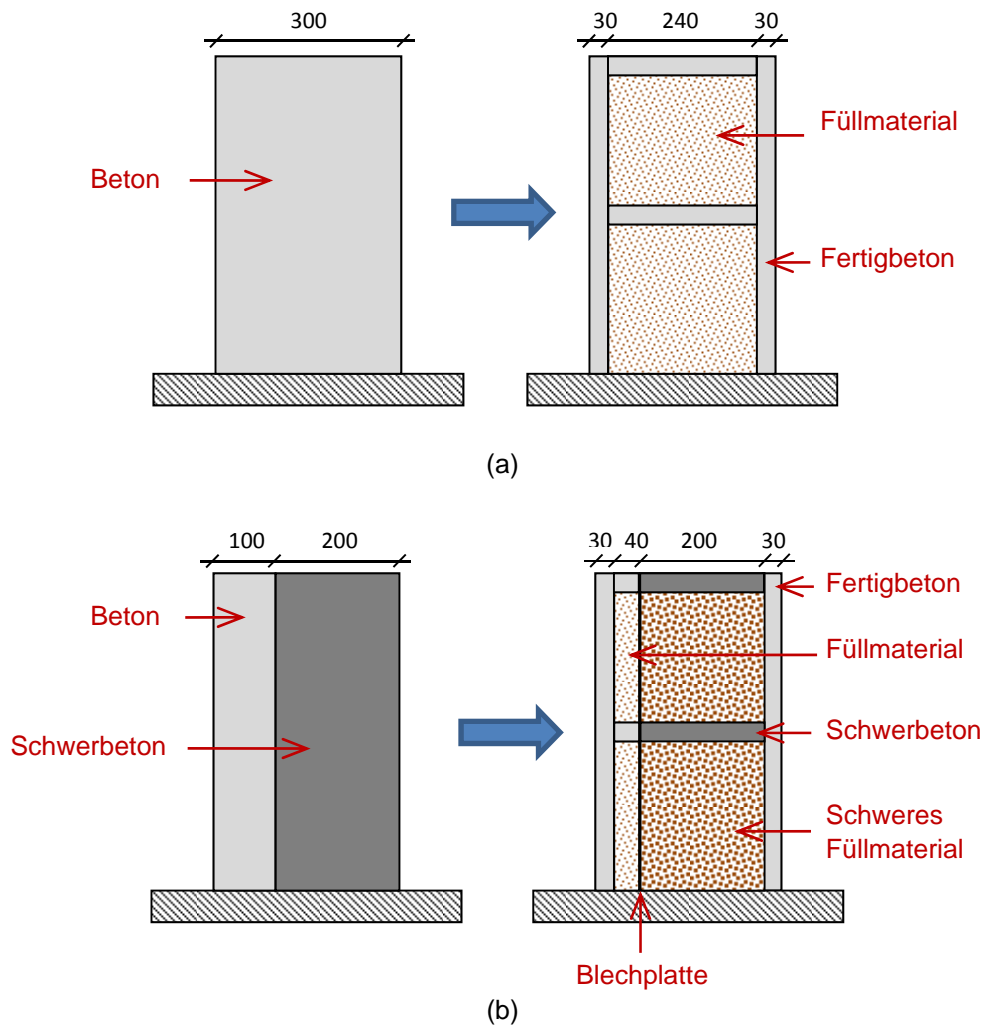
Schematische Darstellung der Umsetzung einer Betonwand (a) und einer schichtweise aufgebauten Wand aus Beton und Schwerbeton (b) in die entsprechende Sandwichbauweise.
